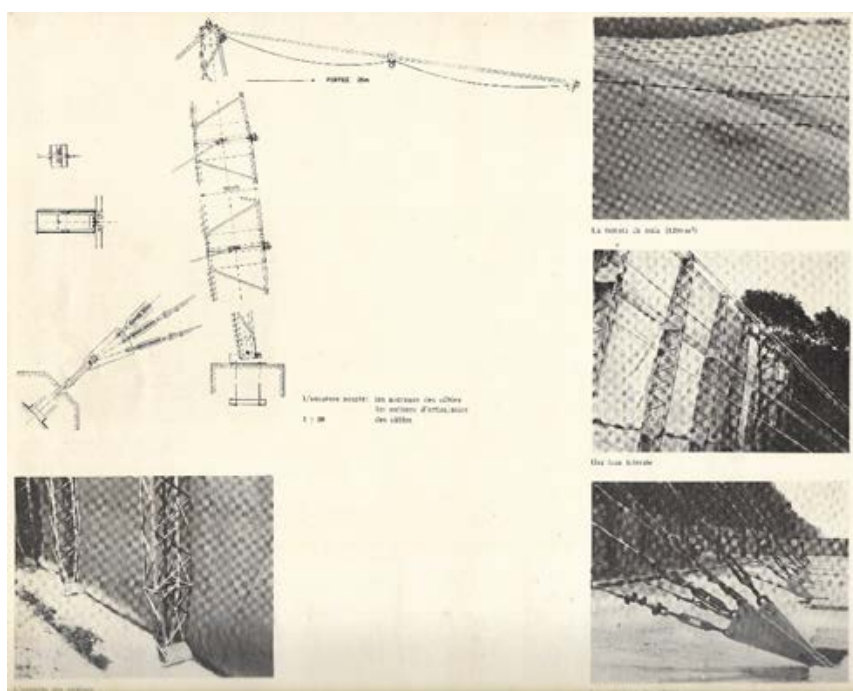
Le Corbusier: Detalhes construtivos da estrutura metálica com os blocos de concreto para ancoragem, pilares metálicos e cabos de aço nas laterais e na cobertura
